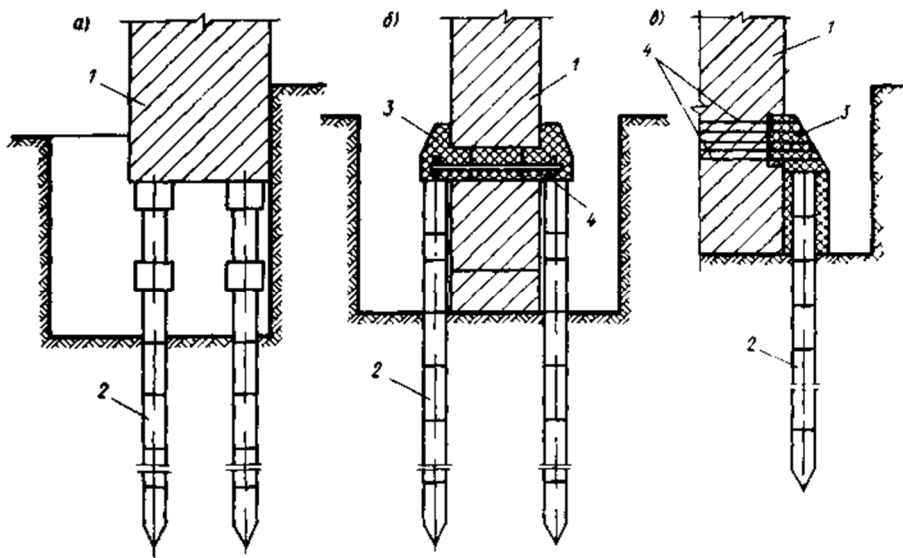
Різноманітні схеми підсилення фундаментів складеними палями:
